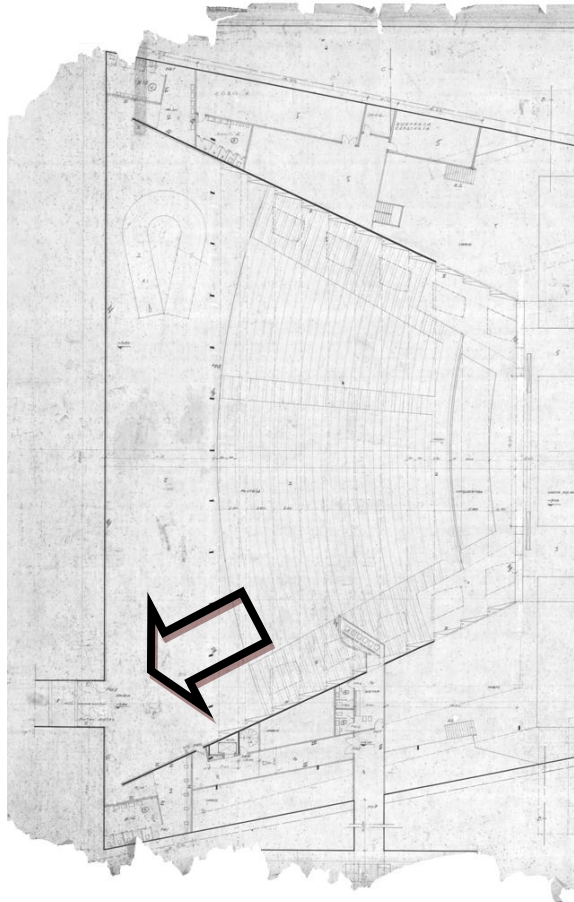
Detalhe - Planta Baixa - Subsolo 1 (sem data). Planta sem carimbo, provavelmente de 1960. Fonte: ARPDP
